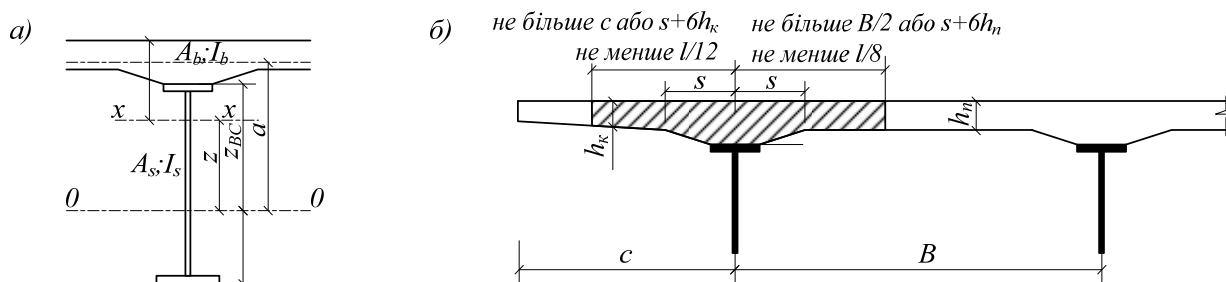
Переріз балки жорсткості сталезалізобетонної шпренгельної конструкції
